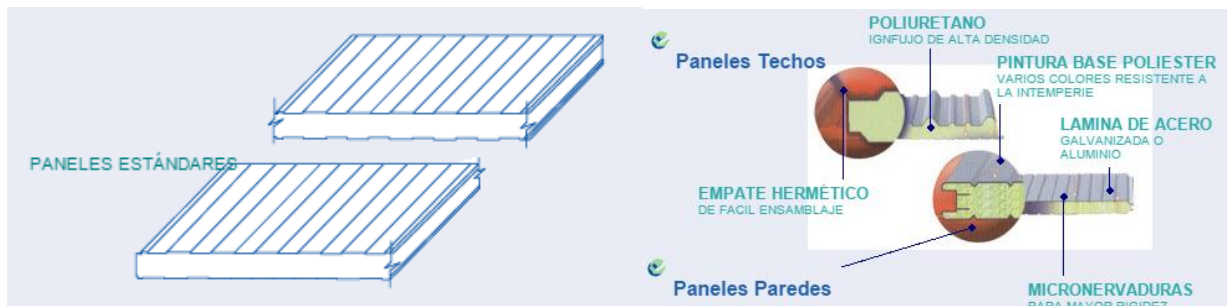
Paneles tipo sándwich MM Refrigeración
